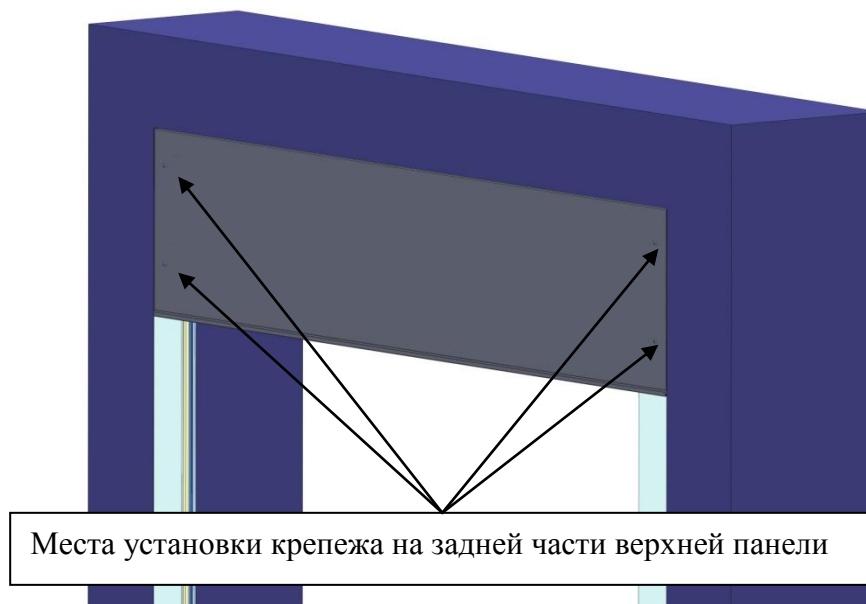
Установка короба SB45/360-M и SB45/405-M
